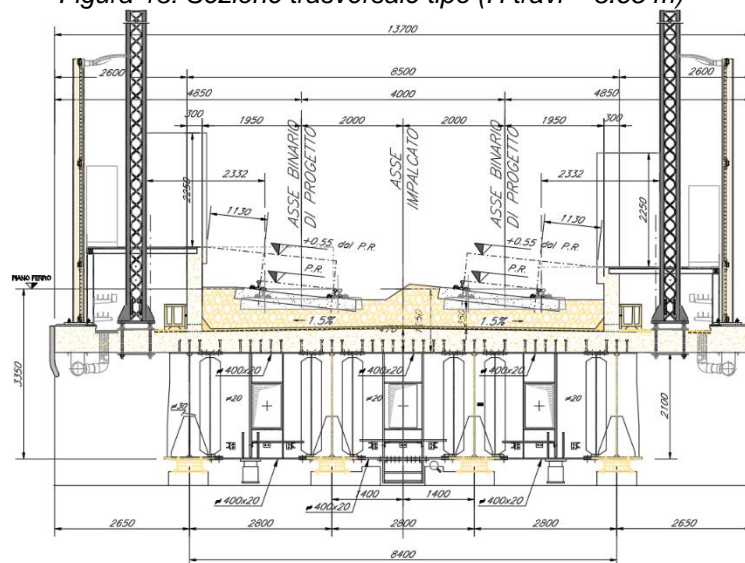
Sezione trasversale tipo (H travi = 2.10 m) – testata
